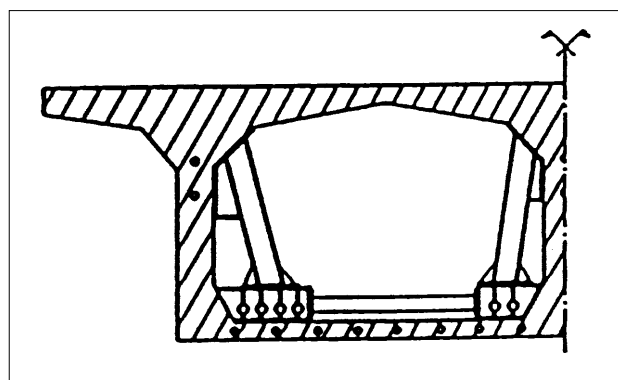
Zone de déviation – introduction des forces au moyen d'une construction en acier (Zahn/Voumard, 1992).
